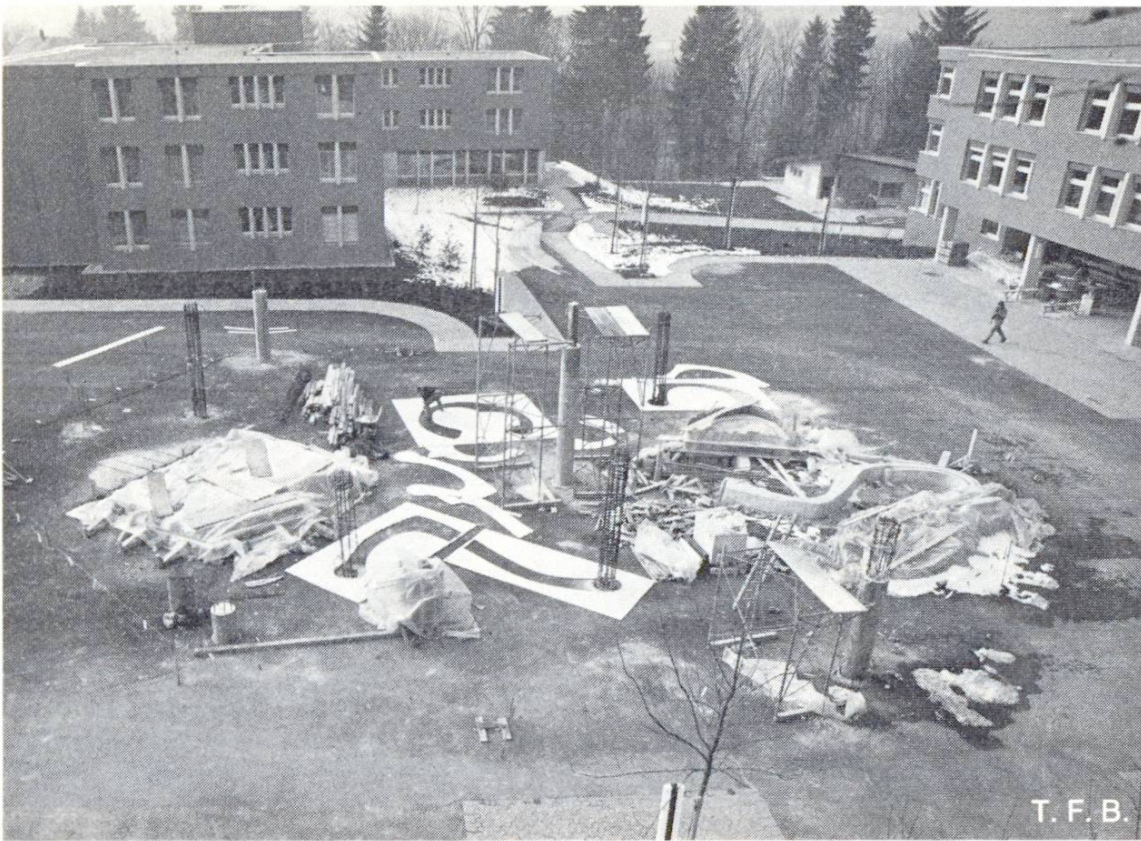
Übersicht über den Bauplatz. Einige Fundamente, Säulen und Brunnenteile sind bereits fertig betonierte. Am Boden erkennt man Schablonen, mit deren Hilfe die Grundrissformen genau festgelegt werden.
